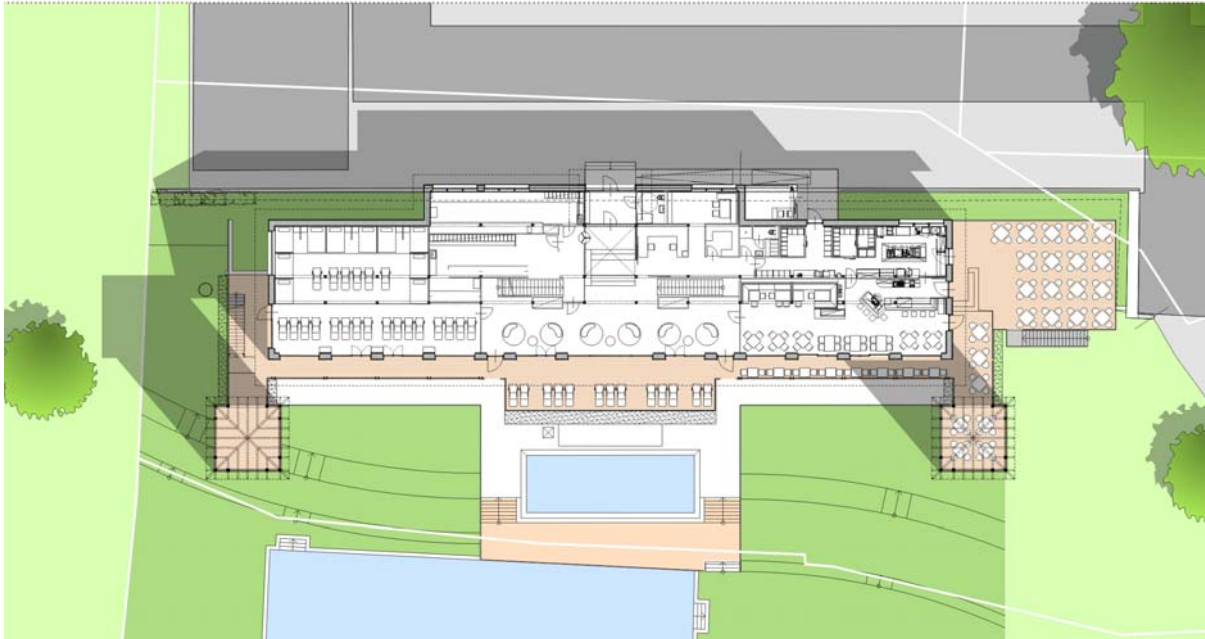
Lageplan des Kärntner Badehauses in Passivhausbauweise in Millstatt
